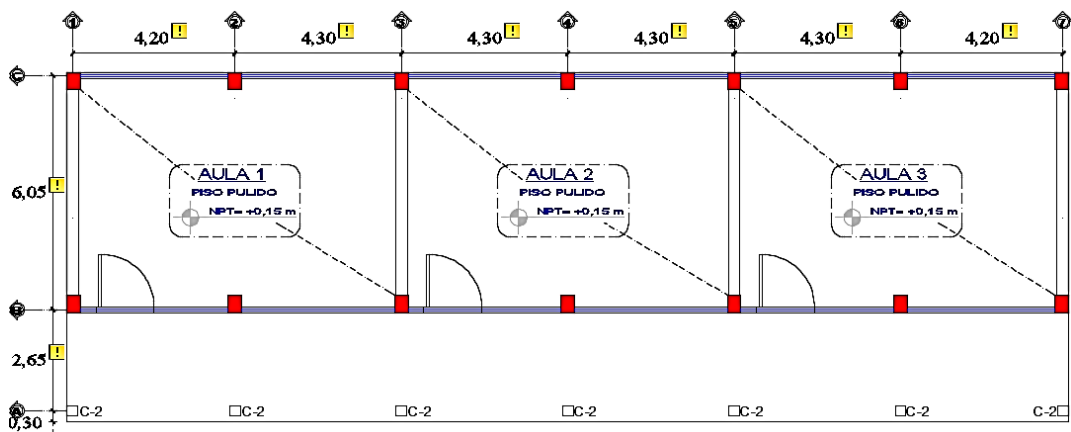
Vista planta del pabellón de la I E Santa Fortunata
